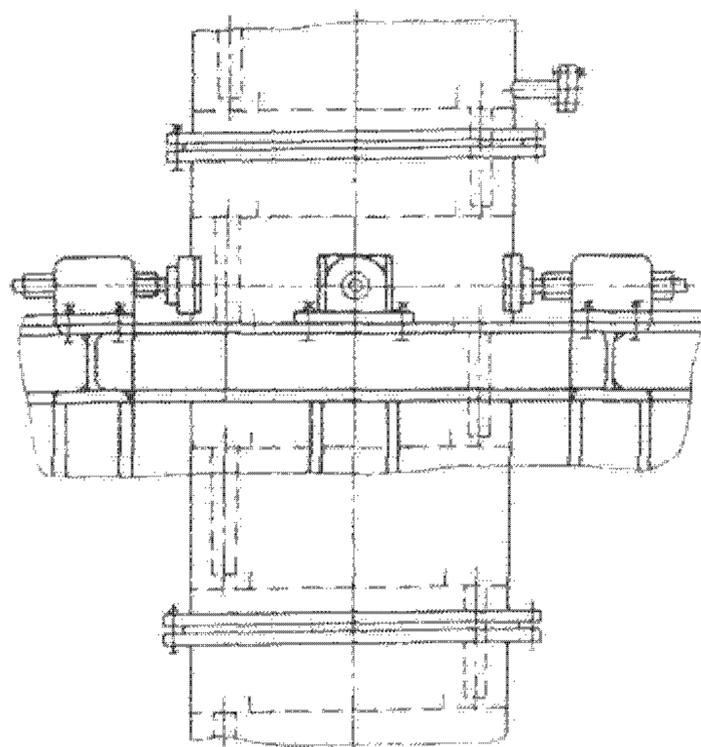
Устройство для раскрепления колонн на площадках (перекрытиях)
